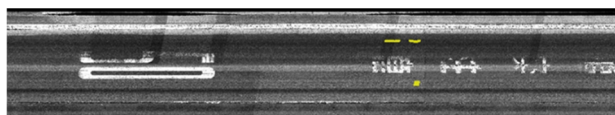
ひび割れ展開図（区間⑧：国道 54 号）
